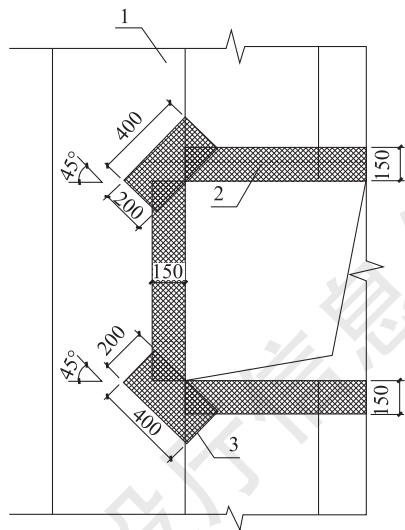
门窗洞口周边耐碱玻纤网布设置示意图
